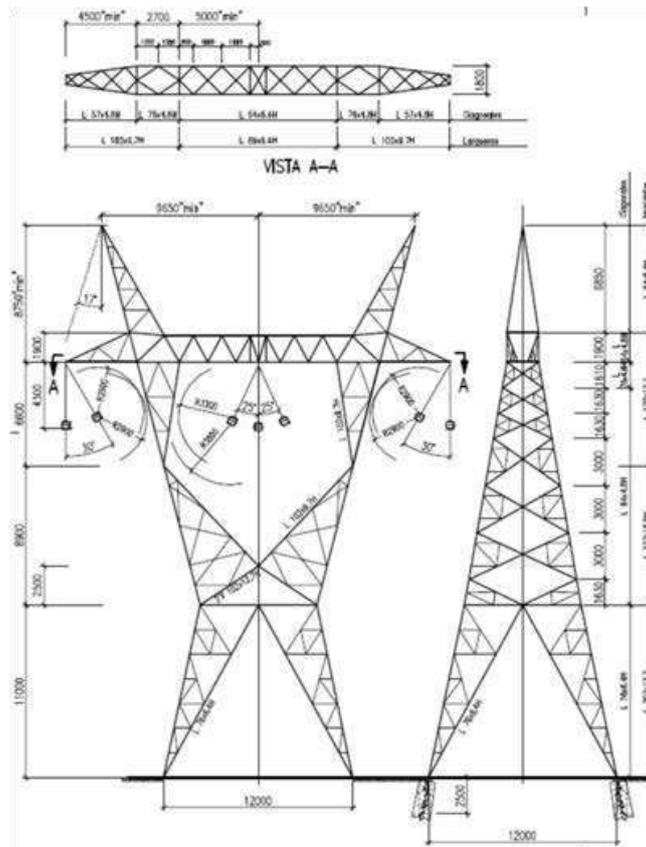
Plano de la Estructura de Retención Angular RA 30°.
